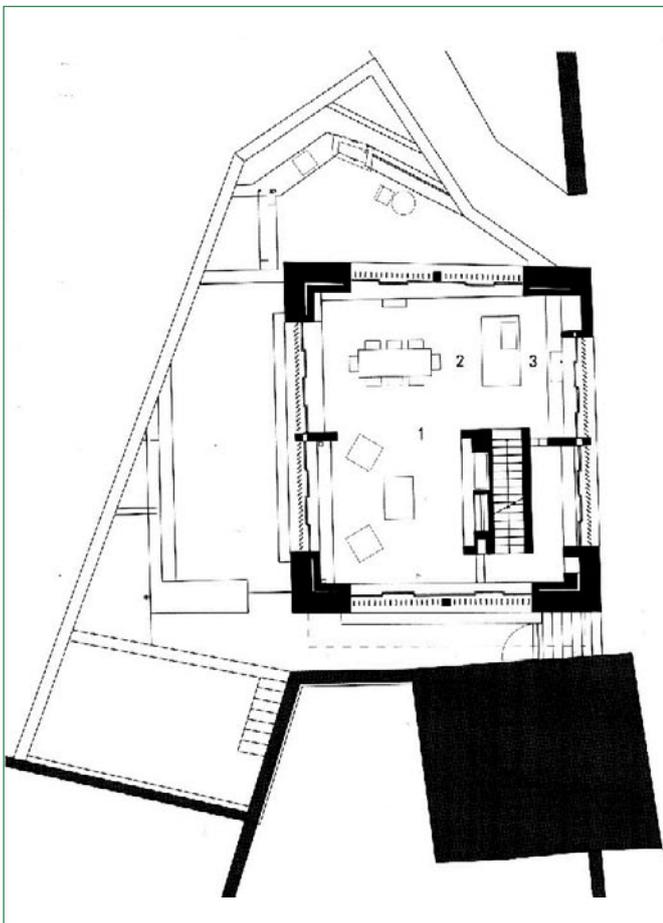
Grundriss 1. Obergeschoss: 1 Wohnen, 2 Essen, 3 Kochen
